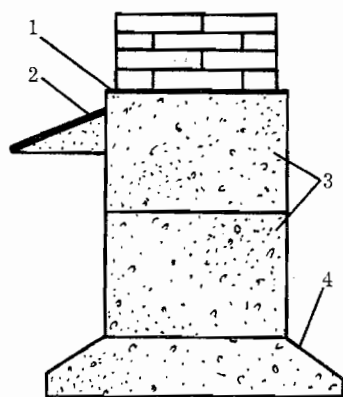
Сборный ленточный фундамент из фундаментных блоков: 1 — горизонтальная гидроизоляция; 2 — отмостка; 3 — фундаментные блоки; 4 — фундаментная плита.
